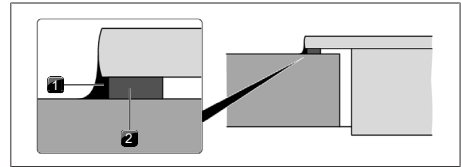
Ruban d'étanchéité pour montage en saillie
